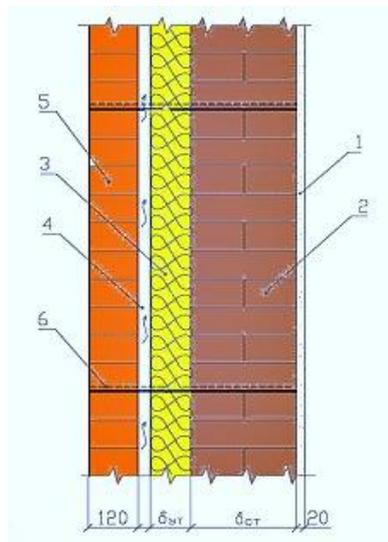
Трехслойная стена. 1 – внутренняя отделка; 2 – несущая стена; 3 – теплоизоляция; 4 – вентилируемый зазор; 5 – облицовка из кирпича; 6 – гибкие связи
